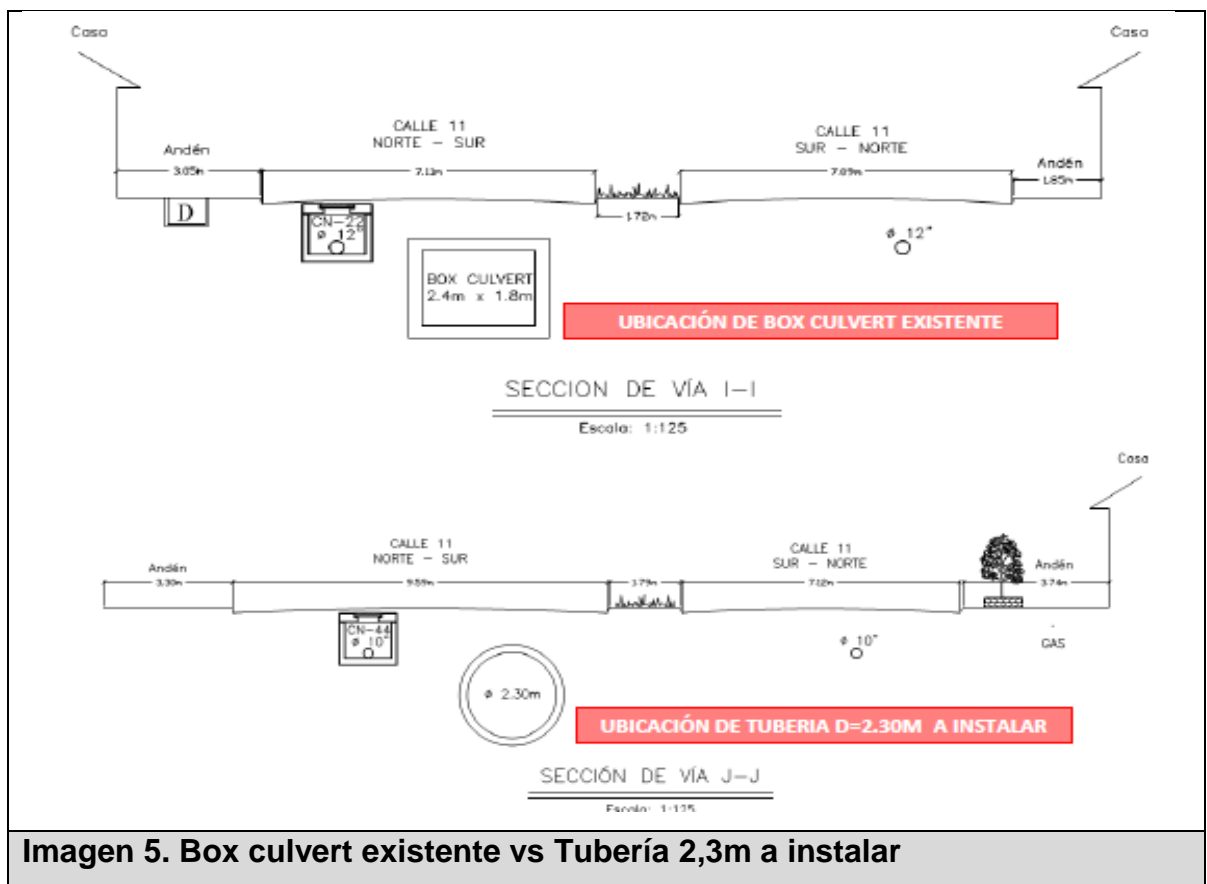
Box culvert existente vs Tubería 2,3m a instalar
